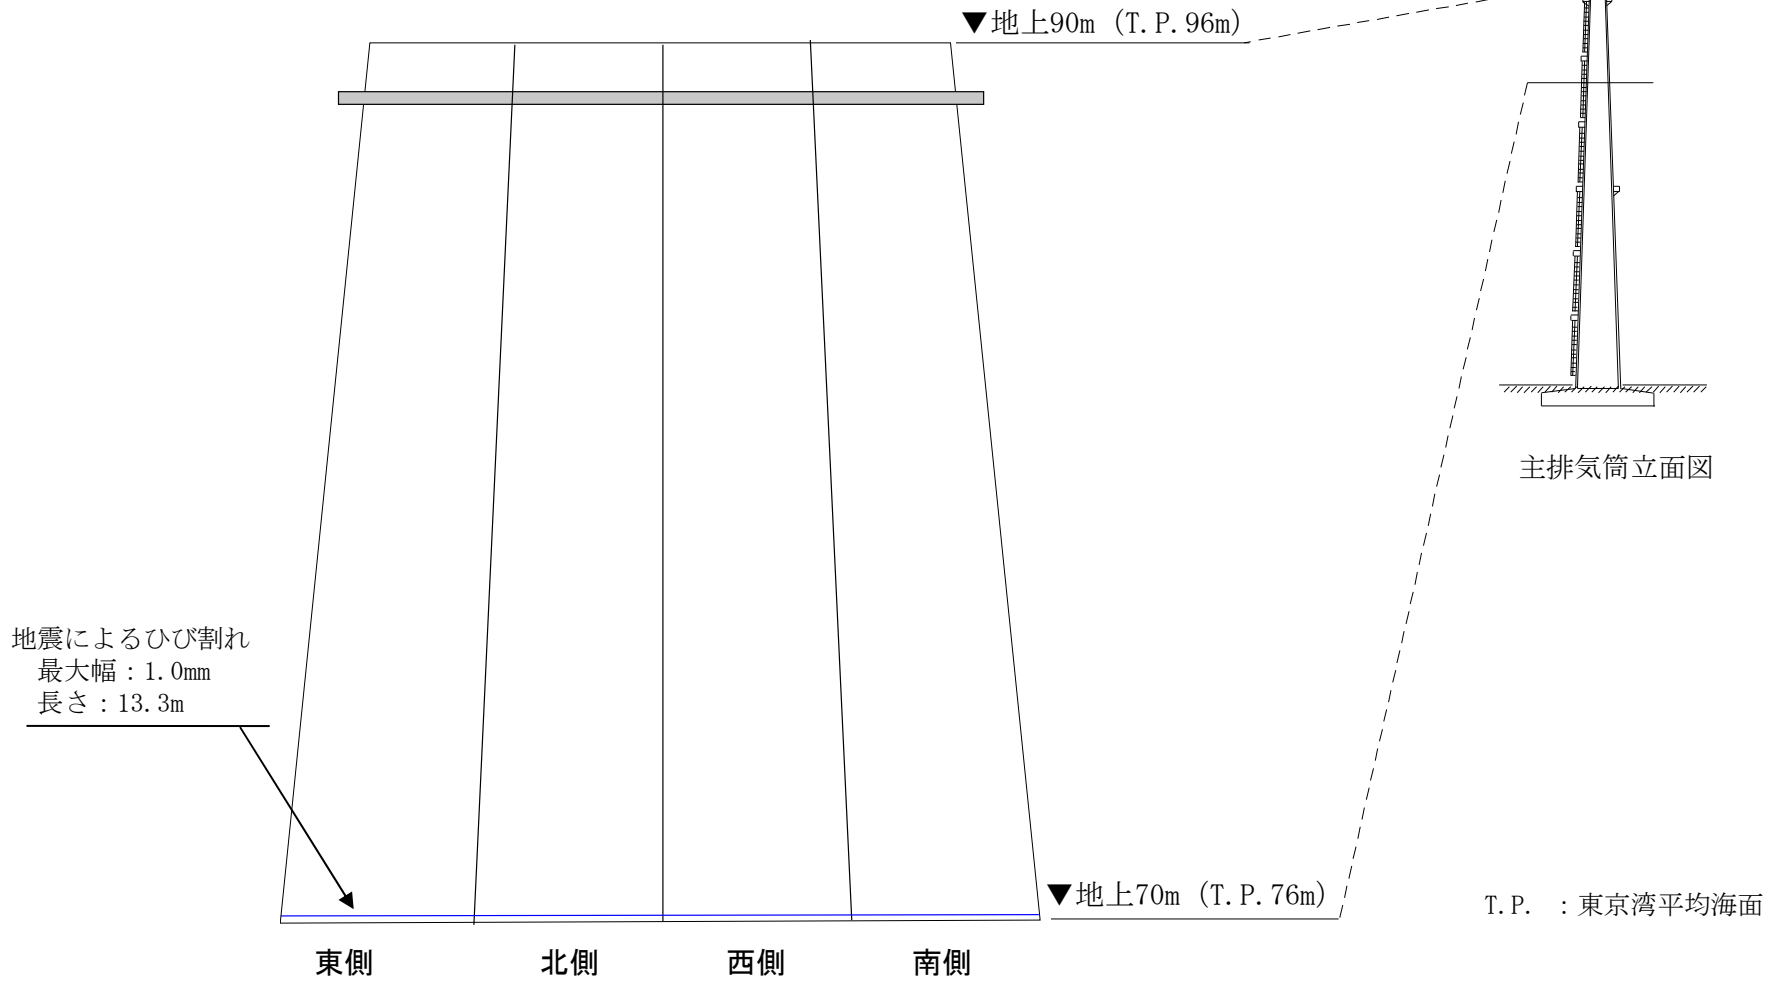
ひび割れの発生状況 主排気筒 (地上高さ 70~90m)
